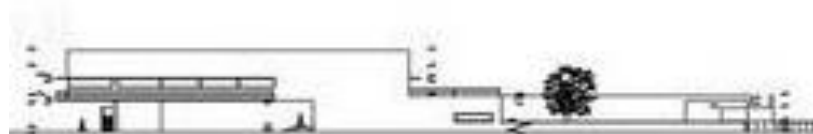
Fachada Lateral y Frontal, Biblioteca Viana Do Castelo
